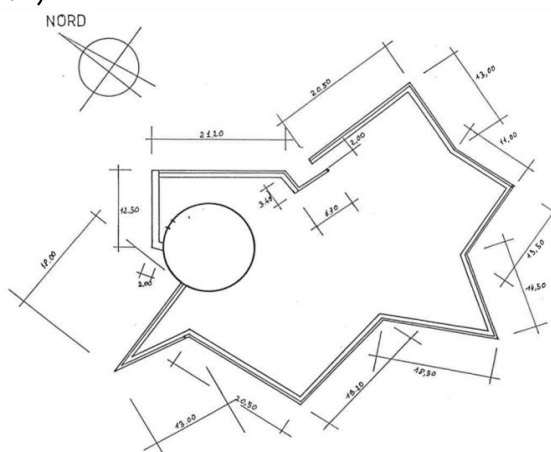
Vue en plan de la fortification par l'architecte Pierre Montserrat
